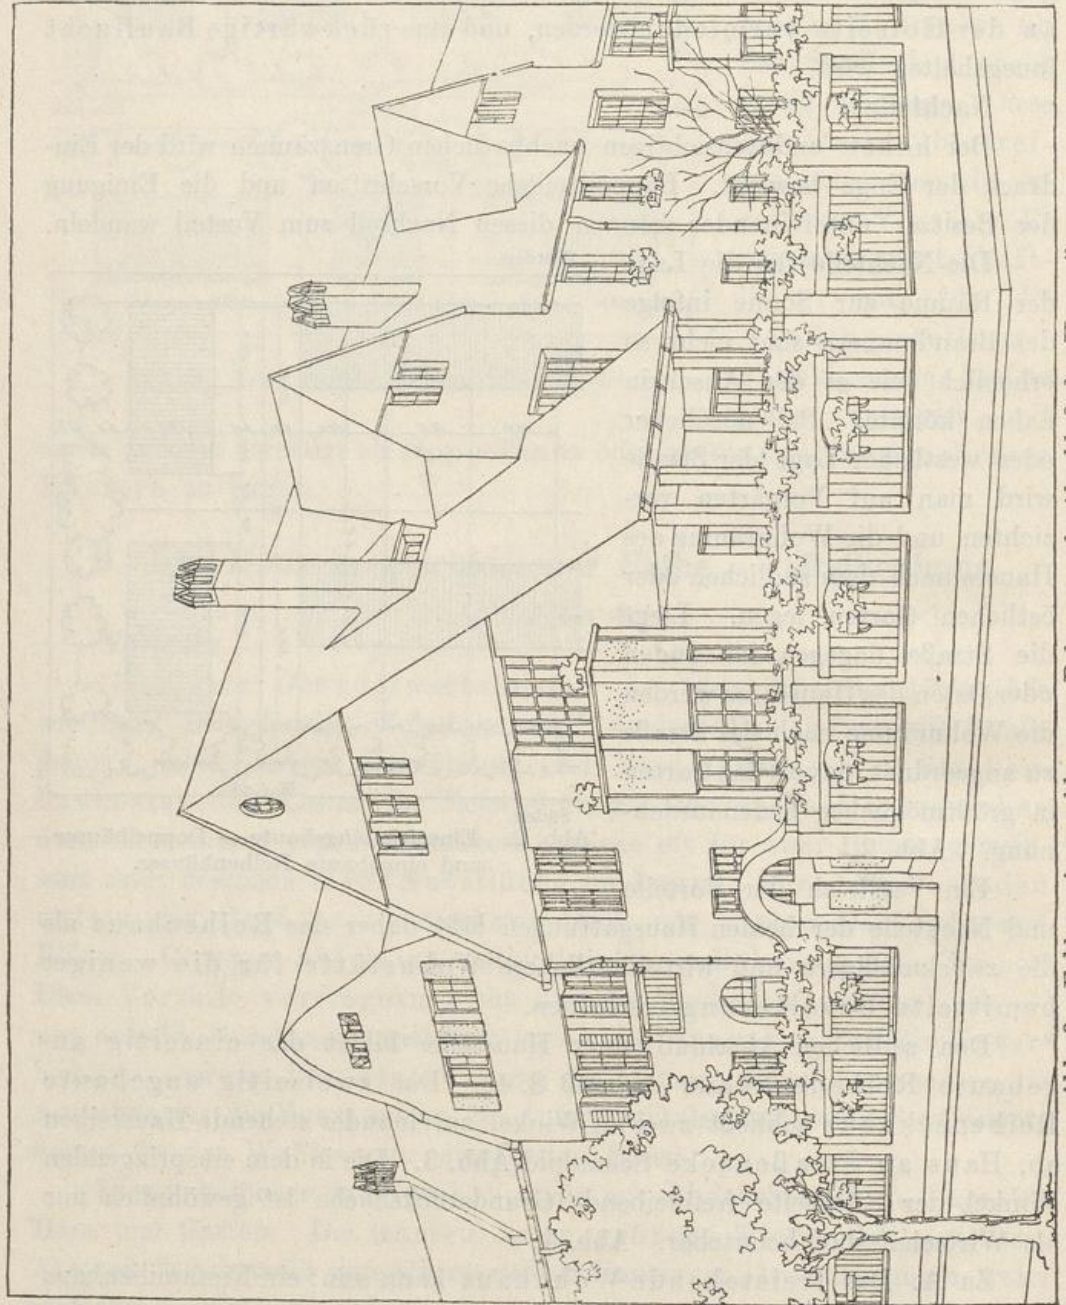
Eckhaus in geschlossener Bebauung als Abschluß der Hausreihen.
